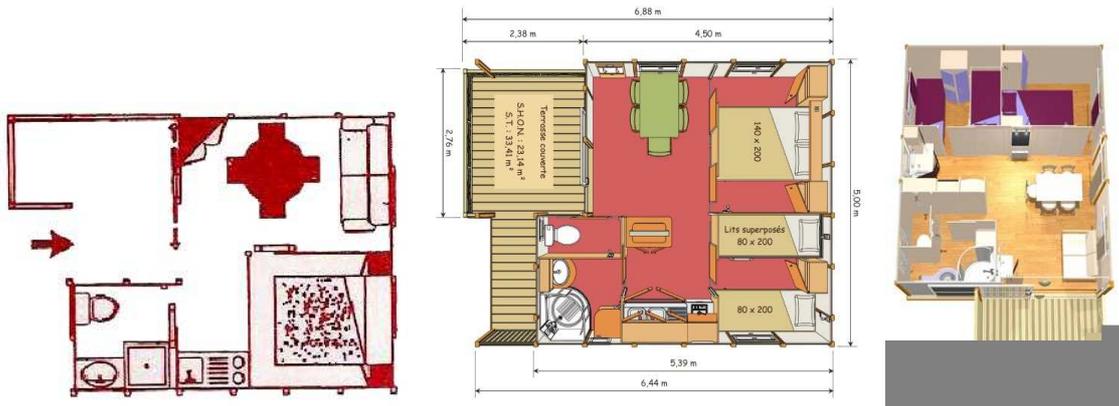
Planta Esquemática bangalôs Camping São Miguel.
